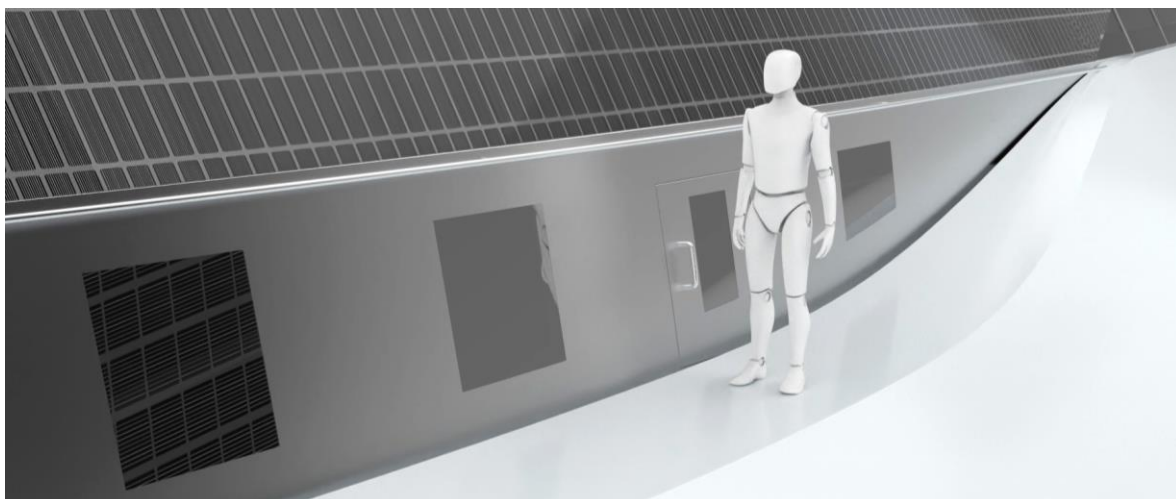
Výsuvné zábradlí kolem heliportu
